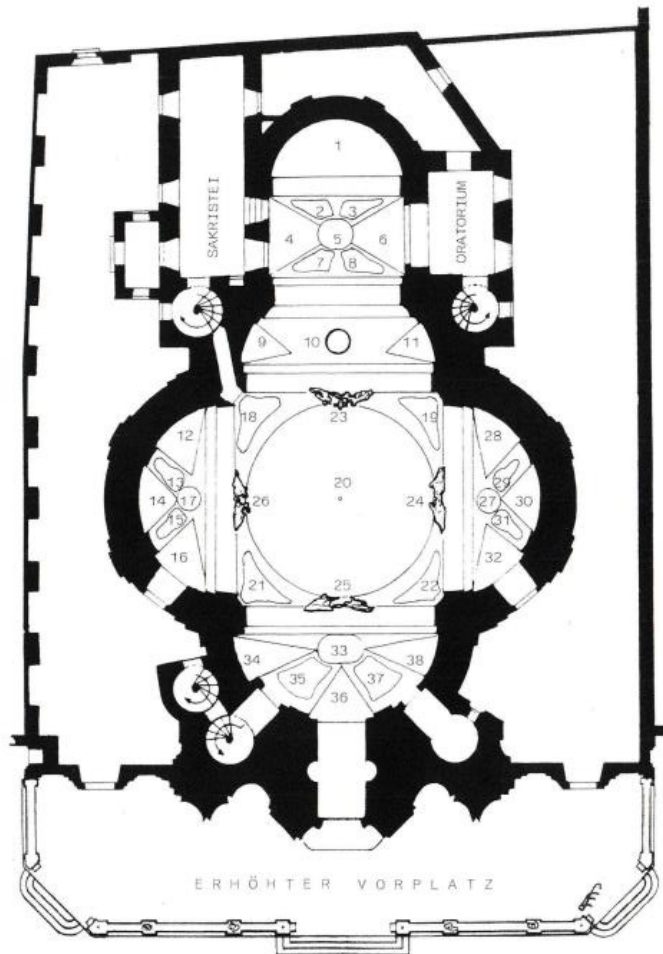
Gewölbeschema: Grundriss mit Erklärung der Ziffern
